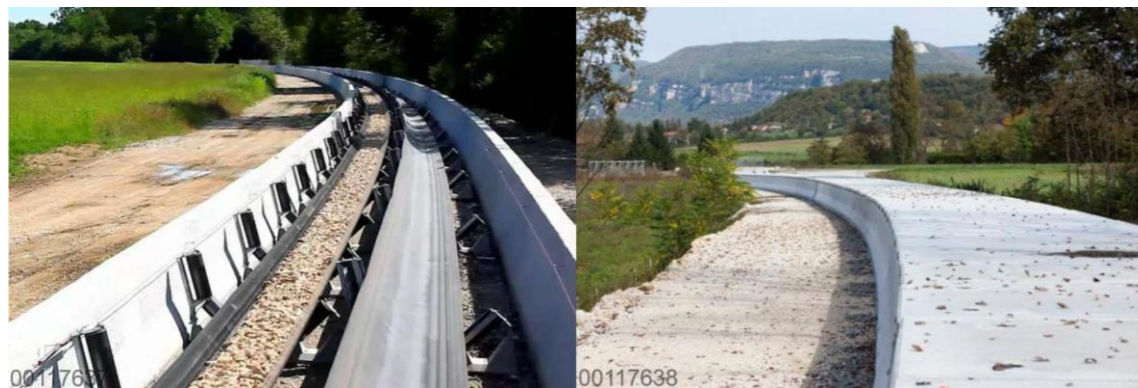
Exemple de convoyeur à bande en caisson béton
